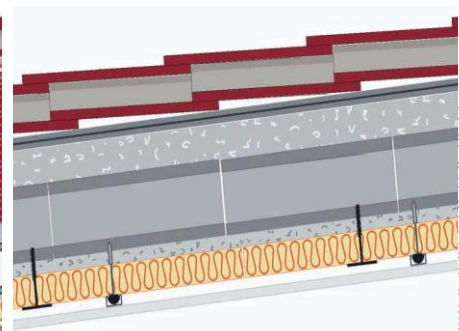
Cubierta sobre forjado inclinado. Aislamiento por el interior.
